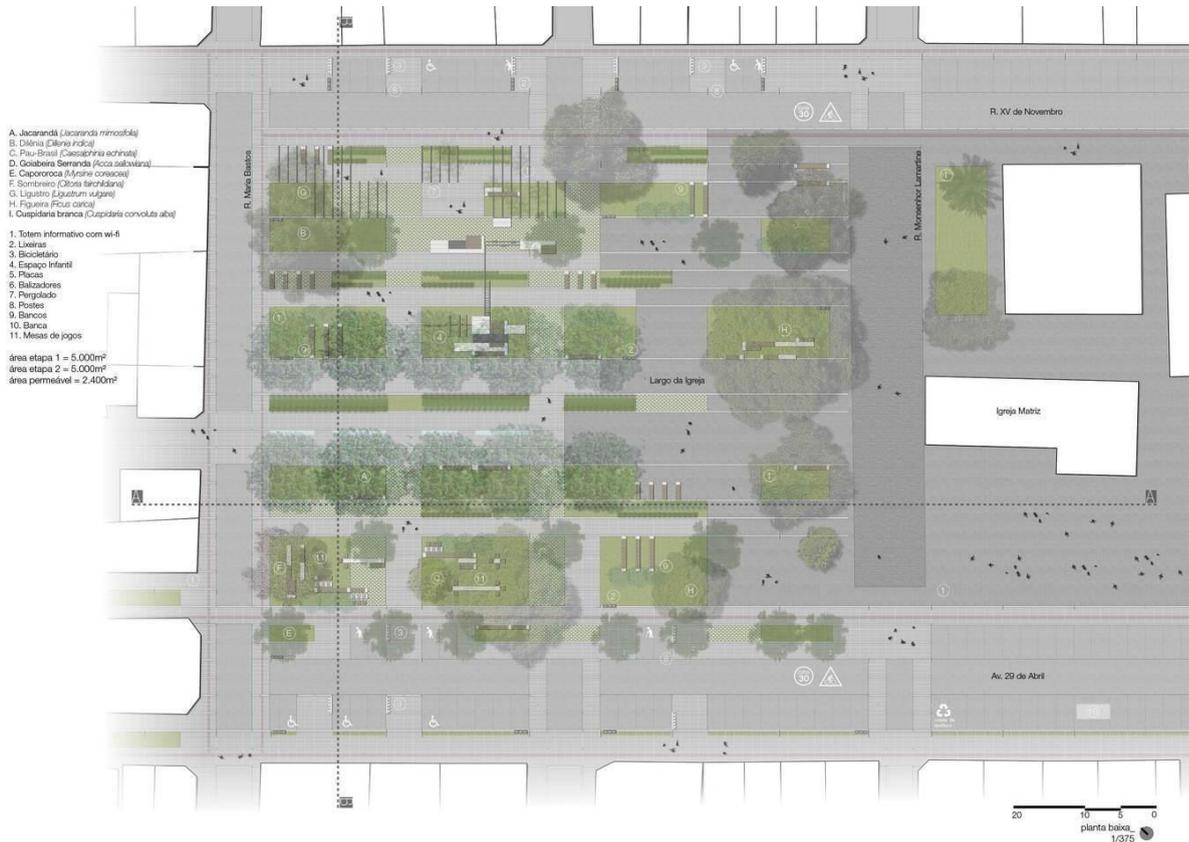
Planta baixa do projeto vencedor do Concurso Nacional para a Praça Central de Guaratuba. Fonte: Bloco B Arquitetura (blocob.arq.br). Acesso em: 08/04/2024.
